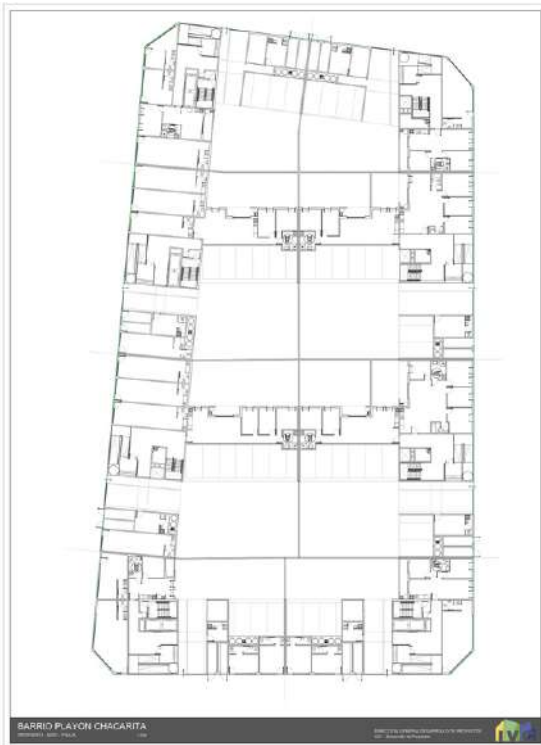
Planta baja de la manzana 1 del primer proyecto presentado en la Mesa Técnica.
